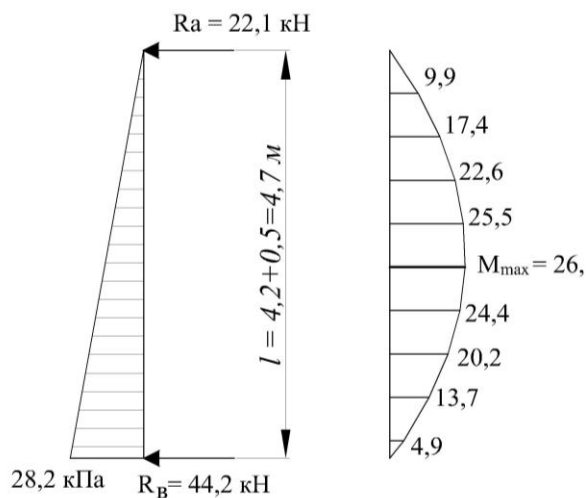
Схема шпунта как балки на двух опорах и эпюра моментов
